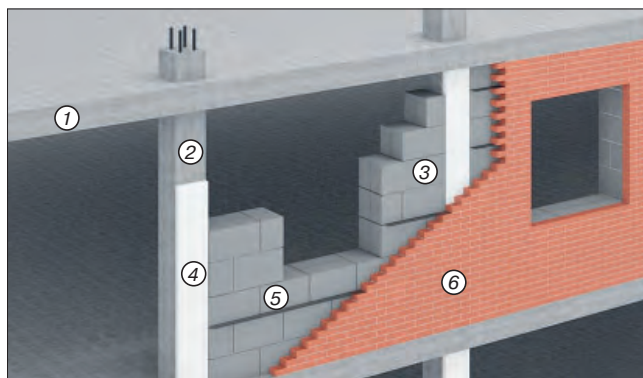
Конструкция наружной стены: 1 – ж/б перекрытие; 2 – несущая ж/б колонна; 3 – полистиролбетонный блок D300 – 330 мм; 4 – полистирол или иной утеплитель, толщина по расчету; 5 – кладочная сетка; 6 – облицовочный кирпич 120 мм
